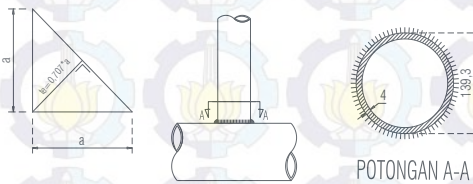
Sambungan las pada tiap joint rangka batang kuda-kuda
